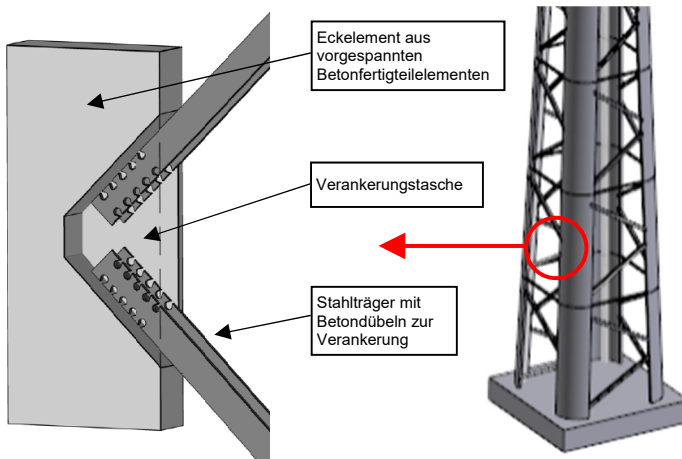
Detail des Hybrid<sup>2</sup>-Turms mit der Verankerung des Stahlfachwerks
